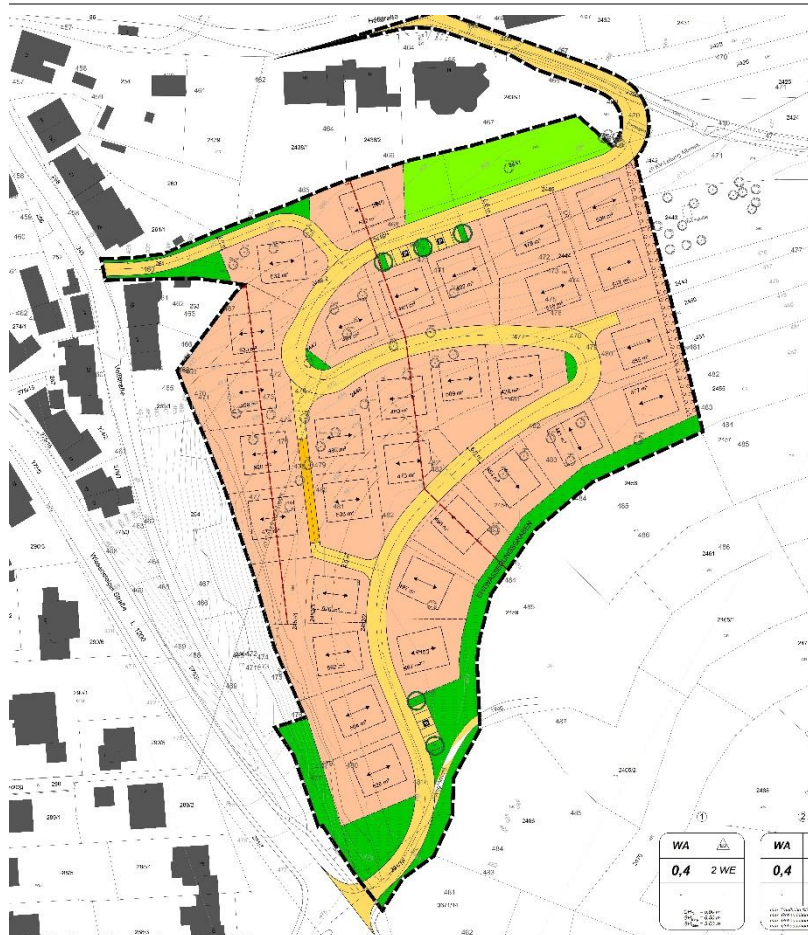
Zeichnerischer Teil Bebauungsplan, Stand Entwurf, Quelle: mquadrat
